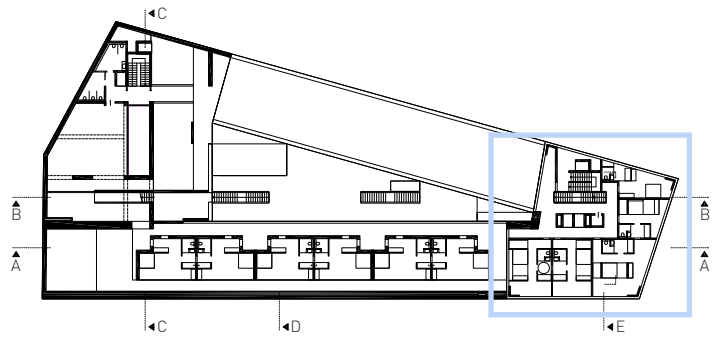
Grundriss Unterkunft Zimmer M1:200
